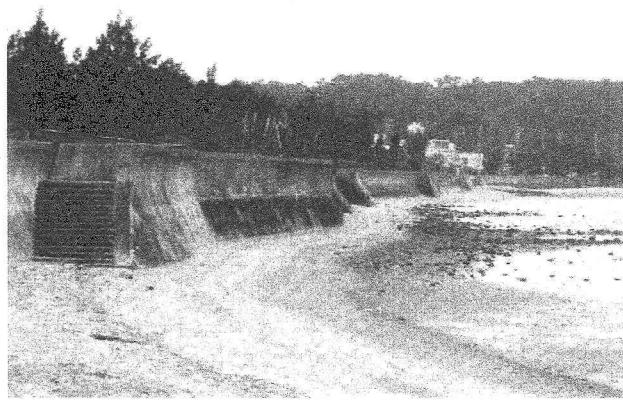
連続するコンクリート傾斜護岸(屋嘉田海岸)
